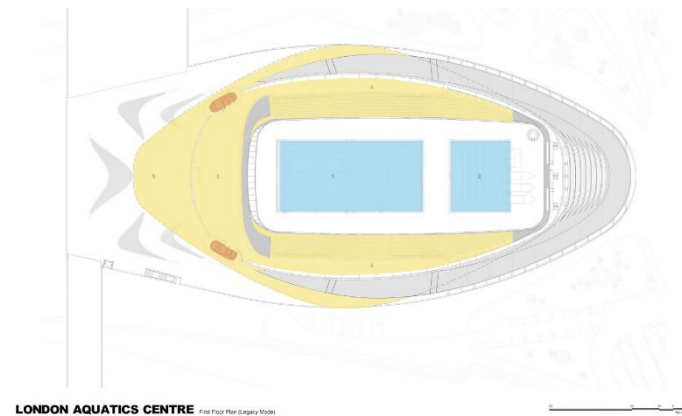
25 Zonasi Ground Floor Plan London Aquatic Centre (Legacy Mode)
